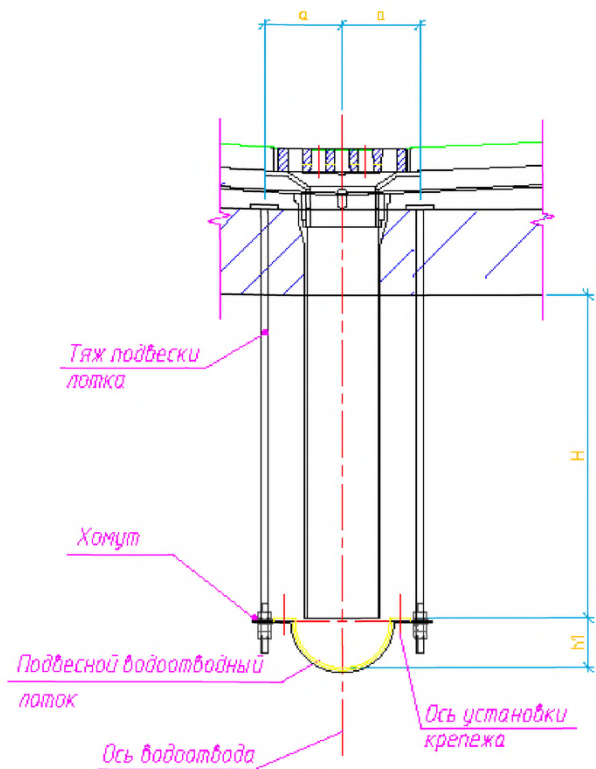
Конструкции крепления подвесного водоотводного лотка из металла:
